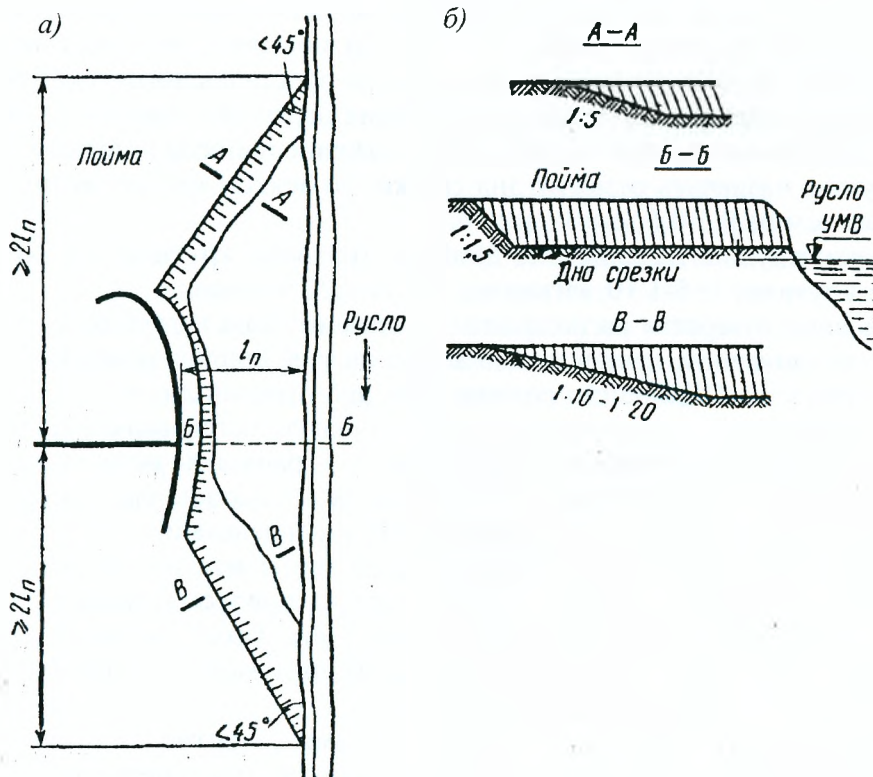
Схема срезки поймы: а – план; б – поперечные разрезы
